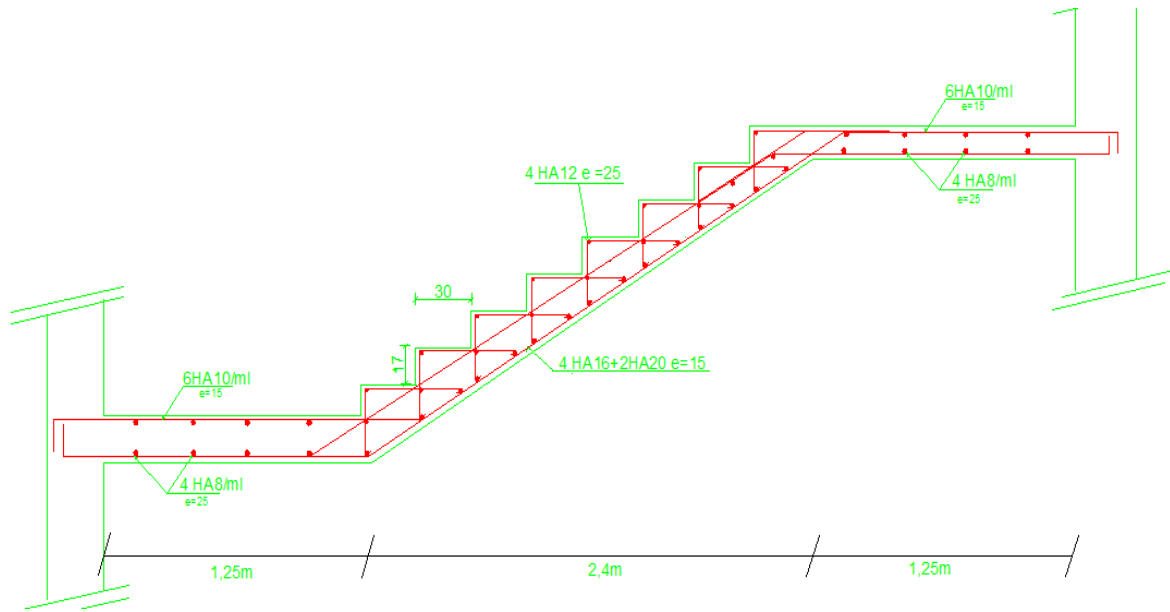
Plan de ferrailage 2^{eme} volée d'escalier d'étage courant H=2,89m
